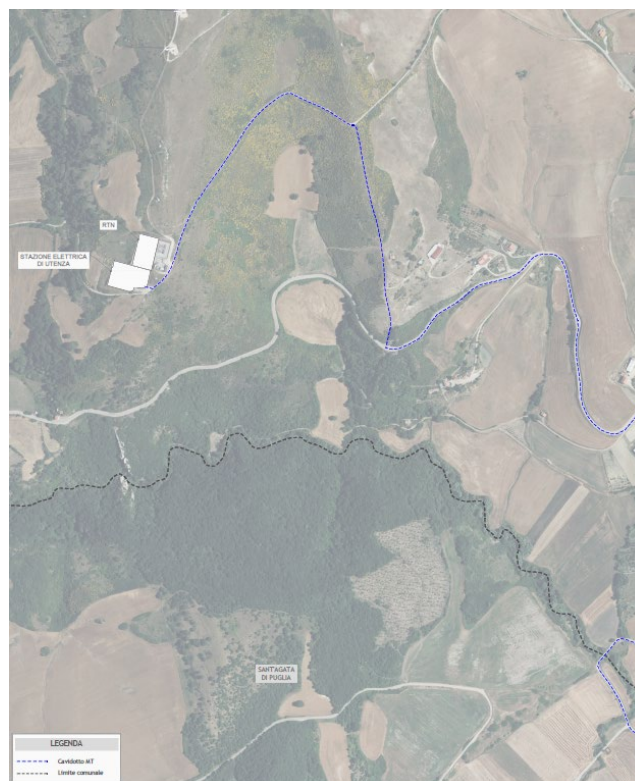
Stralcio della planimetria con individuazione delle opere di connessione su ortofoto
